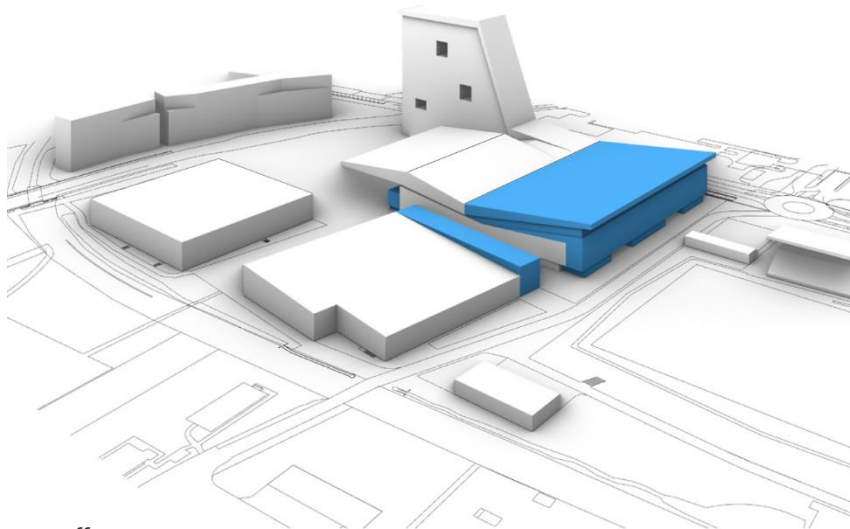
Erweiterung Bossard Arena und Curling- und Trainingshalle (Änderungen in blau)
